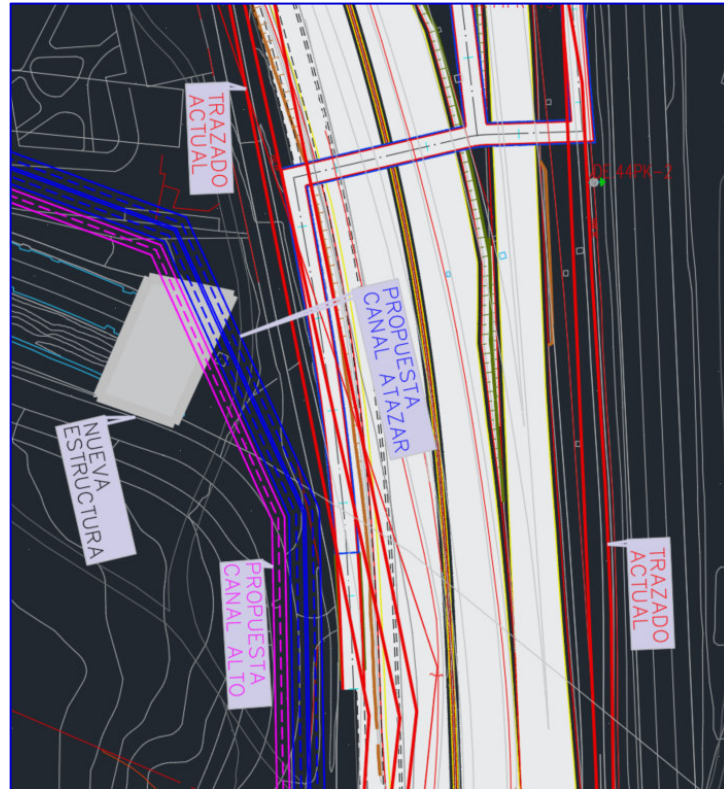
Planta en la que se muestra la nueva estructura para pasar el FFCC.
